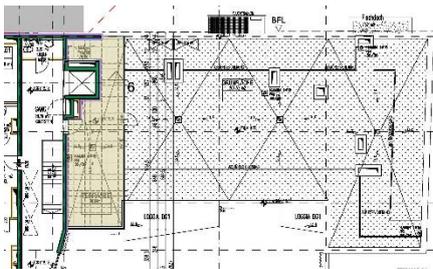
Plan 2. Dachgeschoss: Dachterrasse und extensives Gründach
